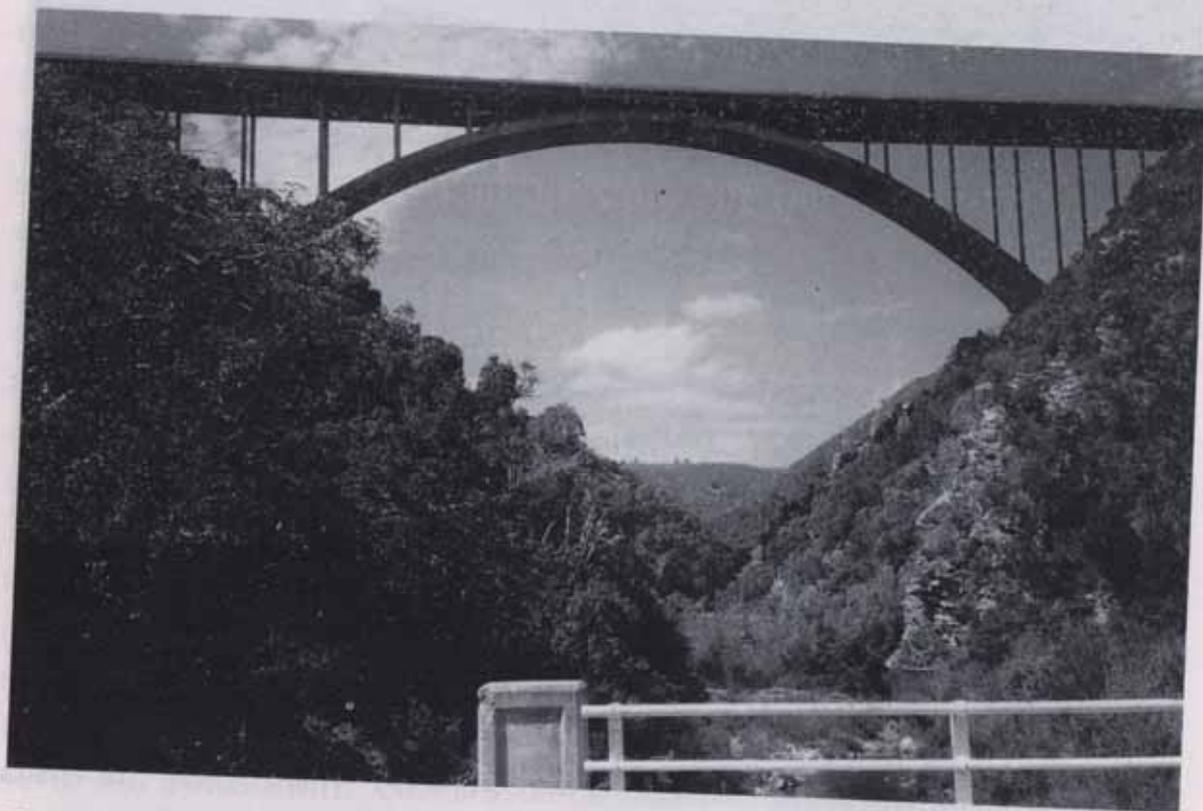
Provincia del Capo, ponte Van Stadens sul fiume omonimo lungo la strada tra Port Elizabeth e Cape Town, costruito negli anni Settanta dall'impresa Di Penta.
